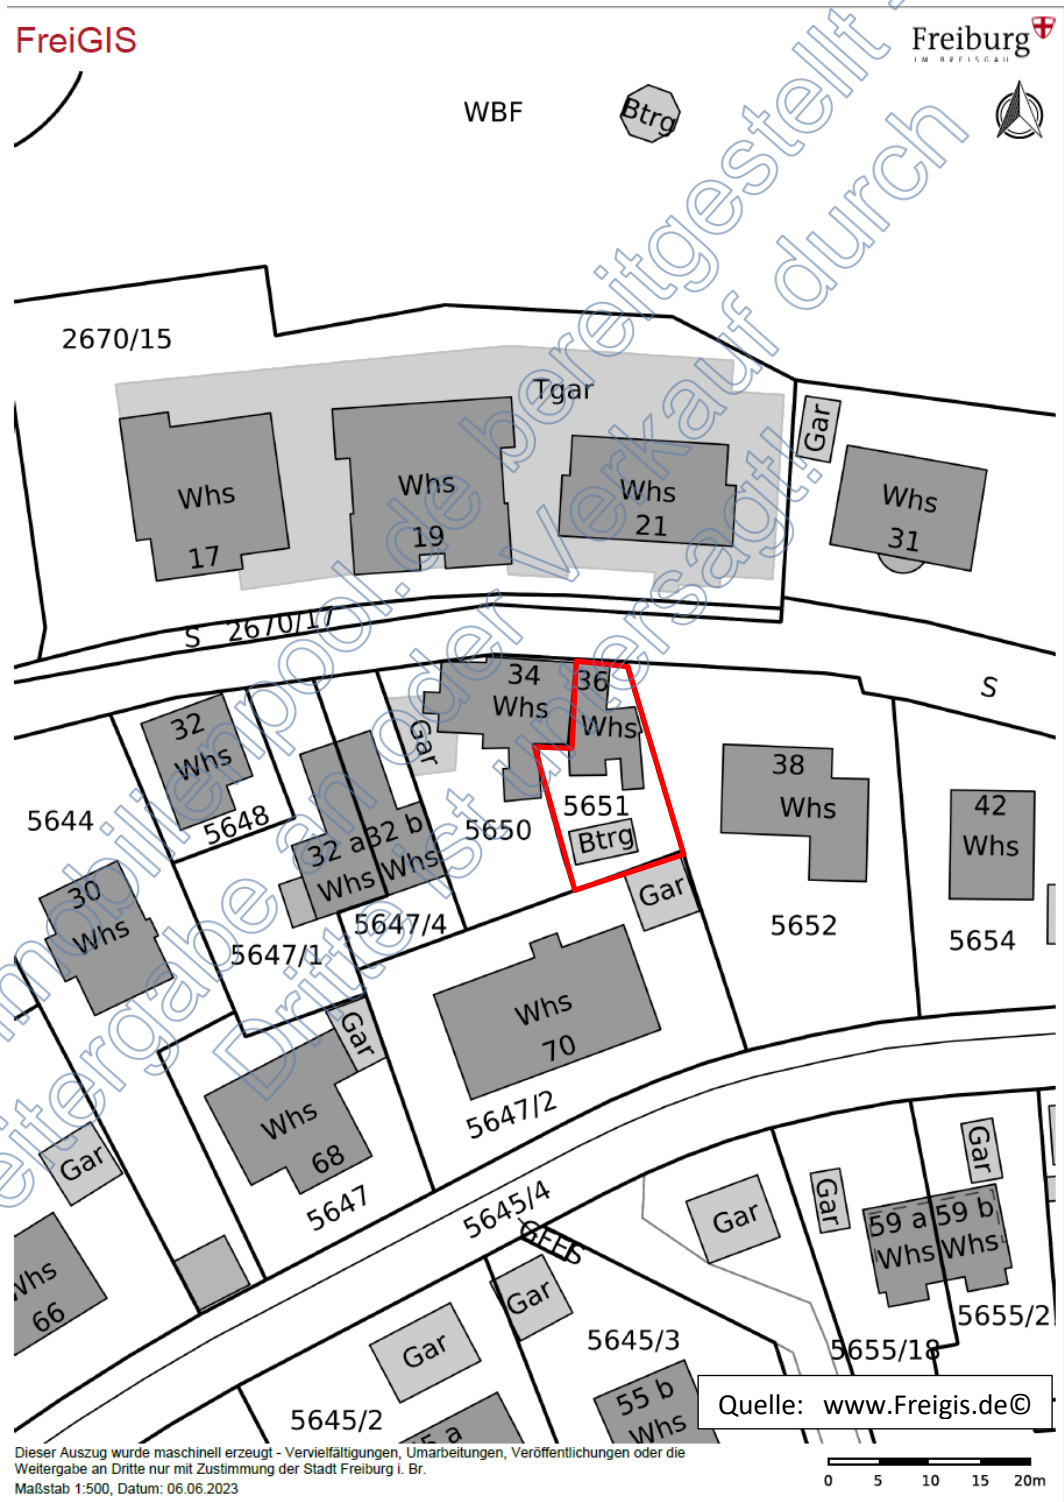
Lageplan FlSt. Nr. 5651 (rot gerahmt)
